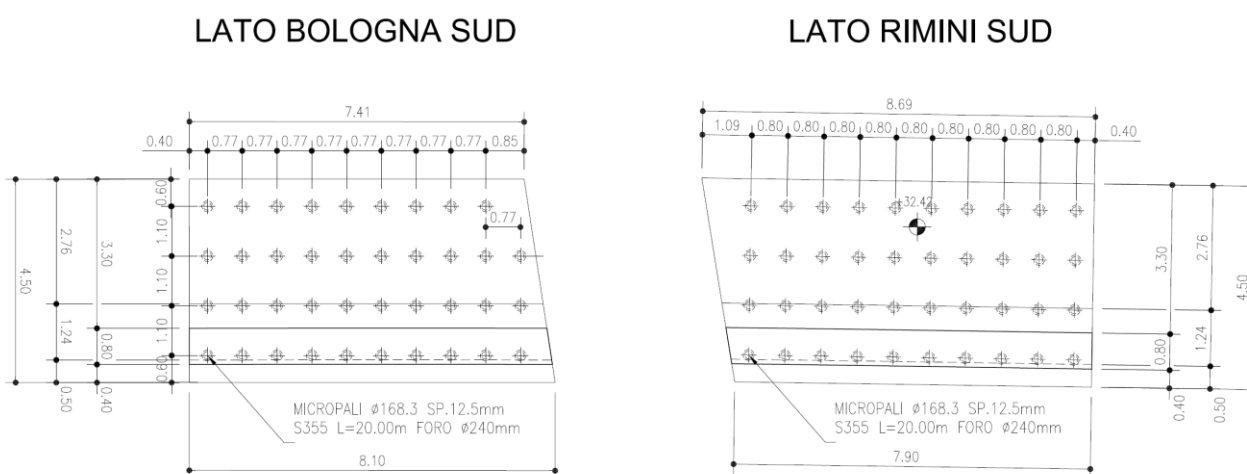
Muri d'ala carreggiata sud – Pianta Fondazioni
